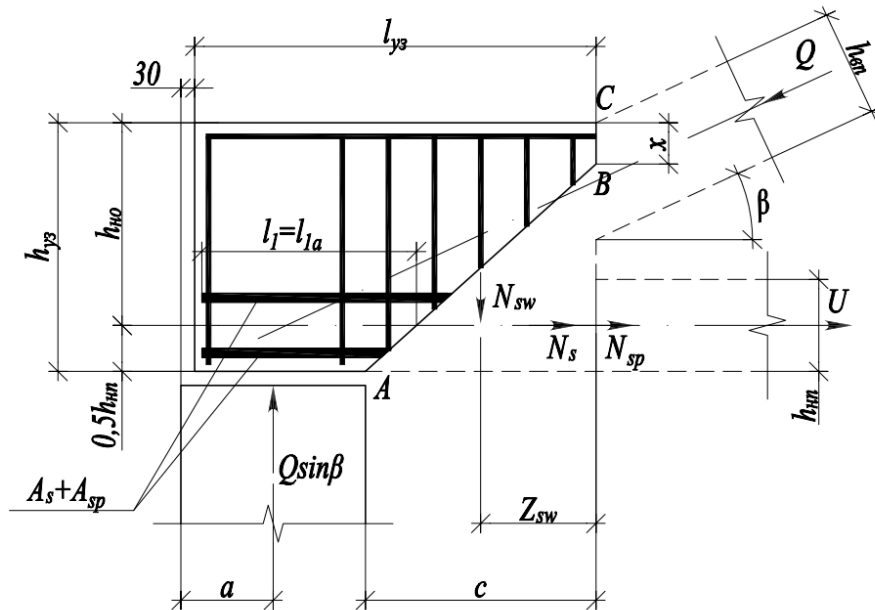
К расчету на изгиб опорного узла в наклонном сечении ABC
